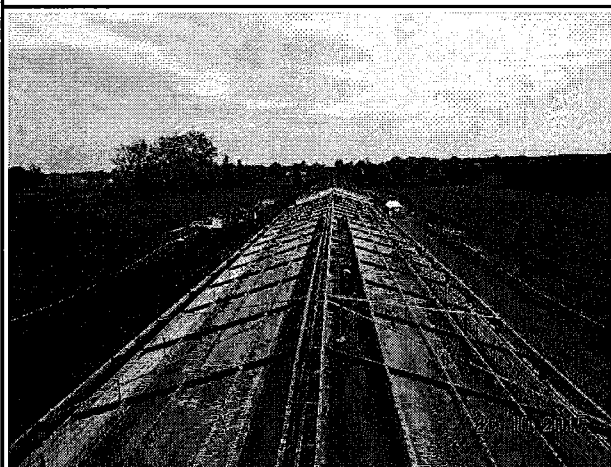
Aanzicht van het dakoverzicht Stal 1 en Stal 2.
